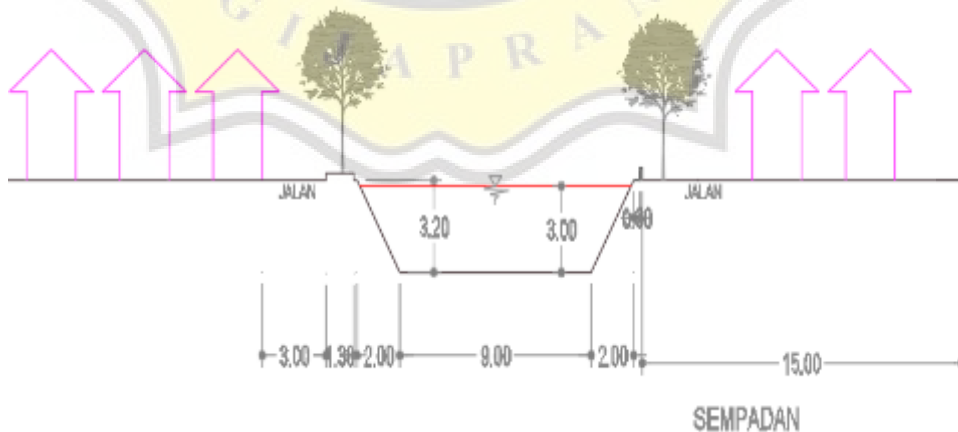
Cross section sungai pepe di Kelurahan Gilingan
